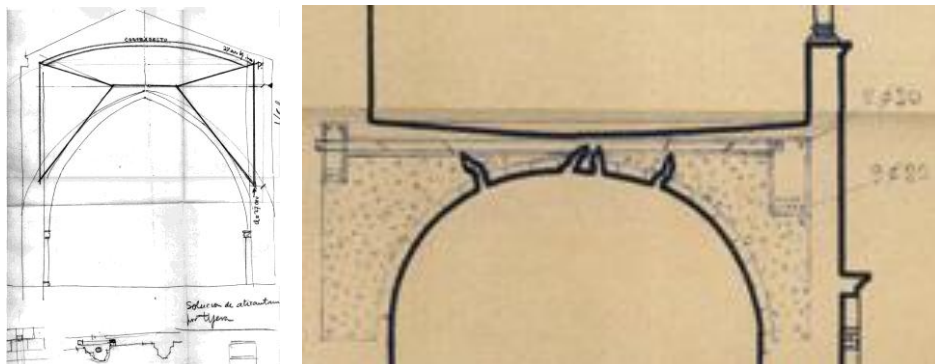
AAFV. Detalles constructivos de propuestas de consolidación de arco y de forjado con atirantamiento de hierro y con vigas de hormigón armado respectivamente. Monasterio de Poblet y claustro del monasterio de Sant Cugat
